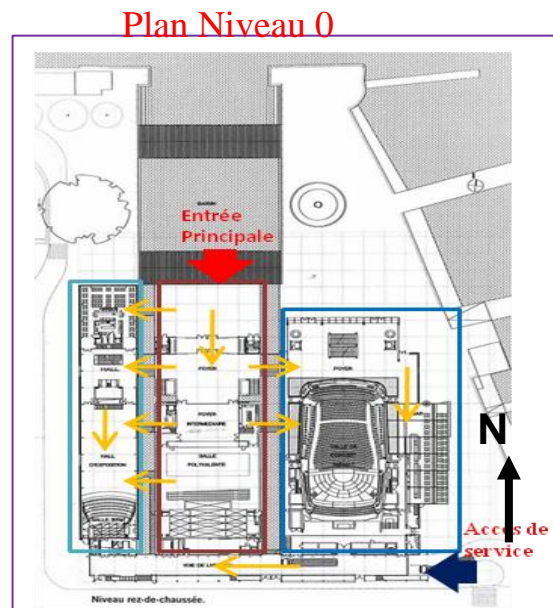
Plan niveau (0) : Source : www.vitruvio.ch
